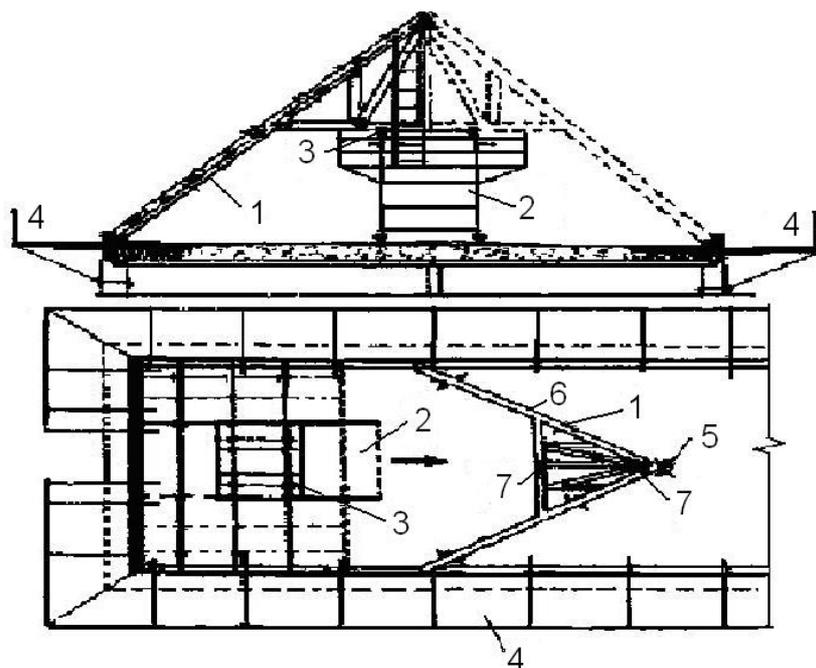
Технологическая схема монтажа деревянных рам: 1 – рама, укрупненная из двух блоков; 2 – передвижные подмости с площадками; 3 – крепежные устройства; 4 – ограждения; 5 – фиксаторы; 6 – укрупнение рамы на кровле; 7 – стыкуемые элементы
